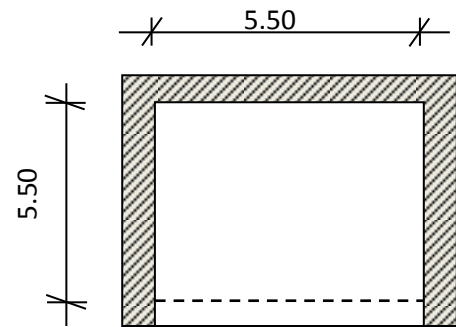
Dimensions du panneau de dalle le plus sollicité
